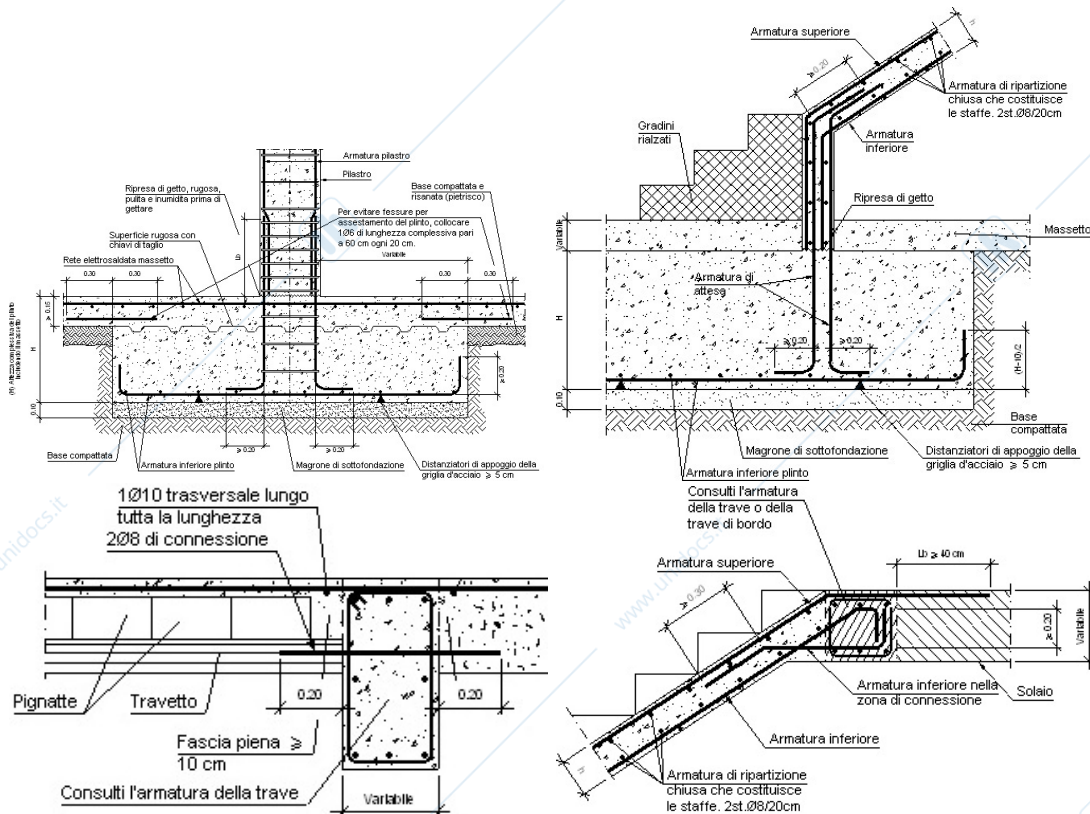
Dettagli della struttura rispettivamente dell'incastro del pilastro, l'incastro alla base della scala, l'attacco tra la trave di sommità e l'inizio delle scale e il dettaglio delle scale stesse;
